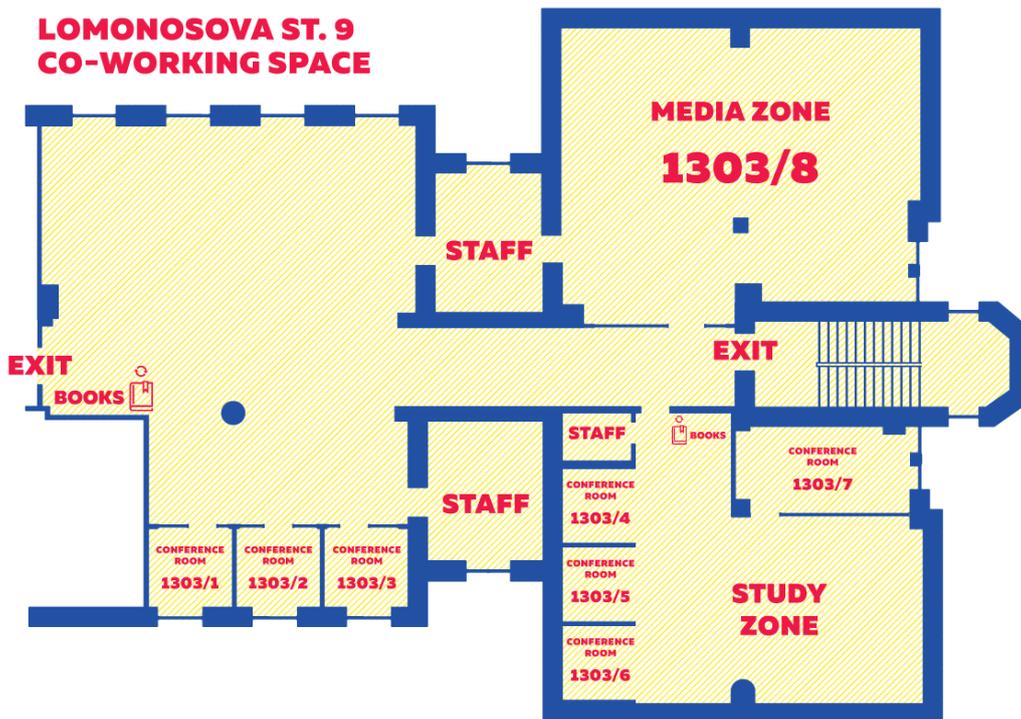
Planta Baix coworking ITMO campus *Lomonosova St.9
